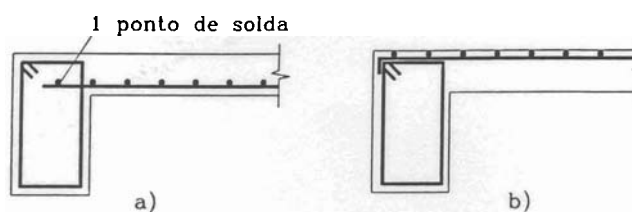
Detalhe de ancoragem de tela soldada em viga externa
